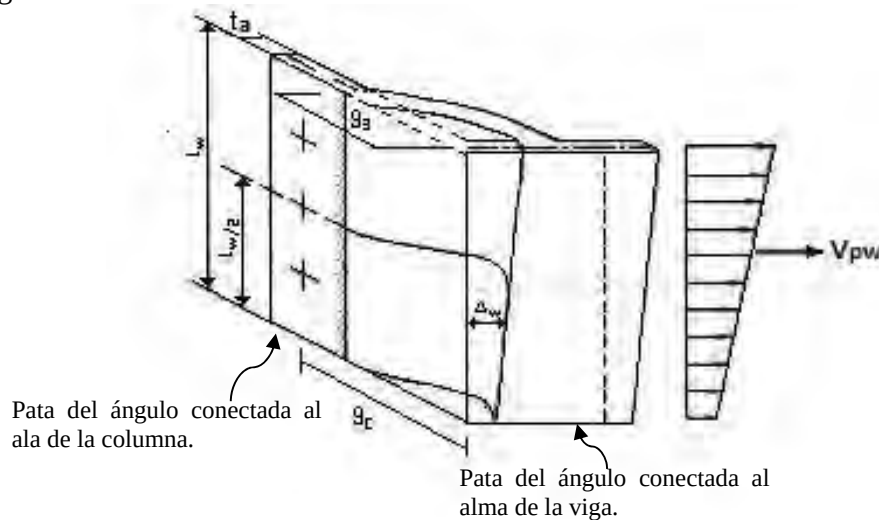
Configuración deformada del ángulo conectado al alma de la viga (Kim & Chen, 1996)
